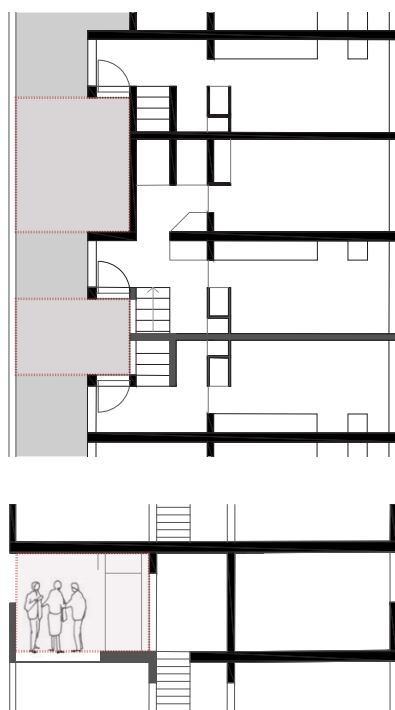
Dimensionamento do vestíbulo/nicho. Planta e Corte transversal. Escala 1:200.
